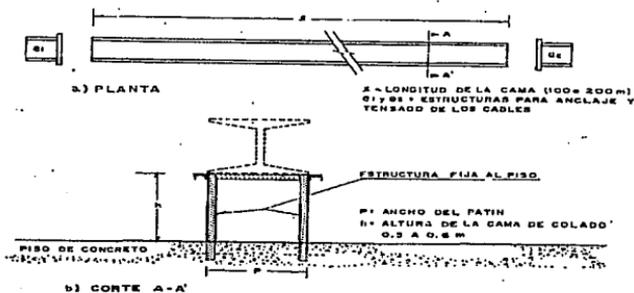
Cama para tensado y colado de pilotes presforzados
